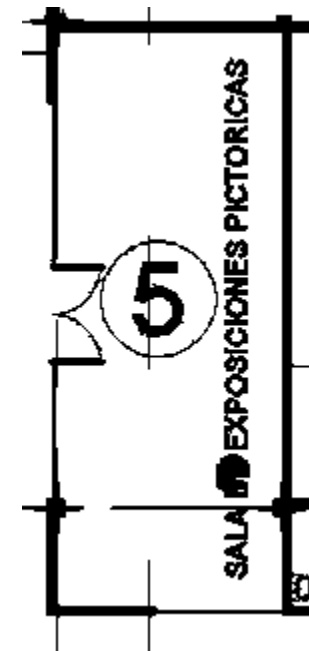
área de estudio. Fuente: Plano arquitectónico del proyecto
